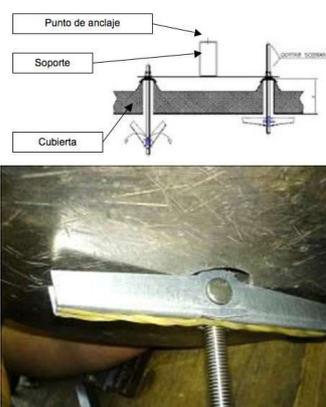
Colocación de soporte para anclaje en cubierta sándwich. Esquema y situación real.
